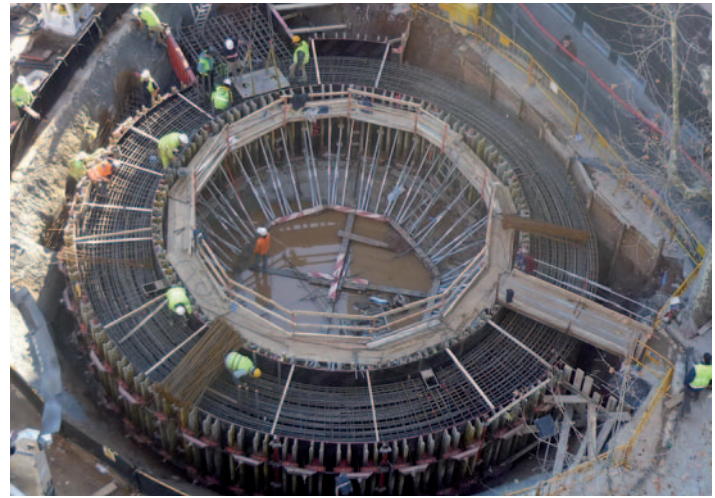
Pilotes de concreto reforzado para resistir las cargas/ Reinforced concrete piles for loads support.
